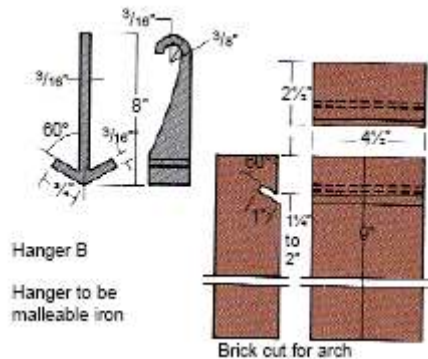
Detalles constructivos de anclas y ladrillo tipo B de 9" de espesor.
